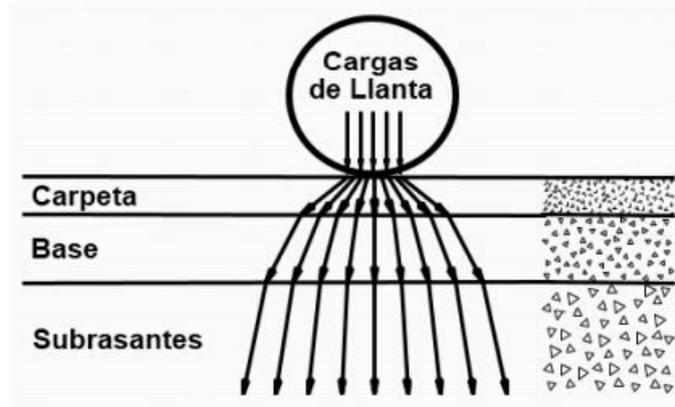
Transmisión de cargas en un pavimento rígido Fuente Introducción a la ingeniería de pavimentos, Ing Andres Sotil Ch.
